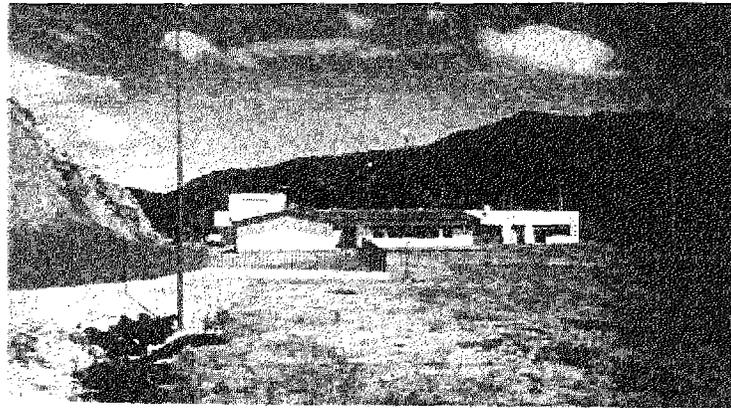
Vista general del terraplén donde se desplanta la estructura del Hospital
